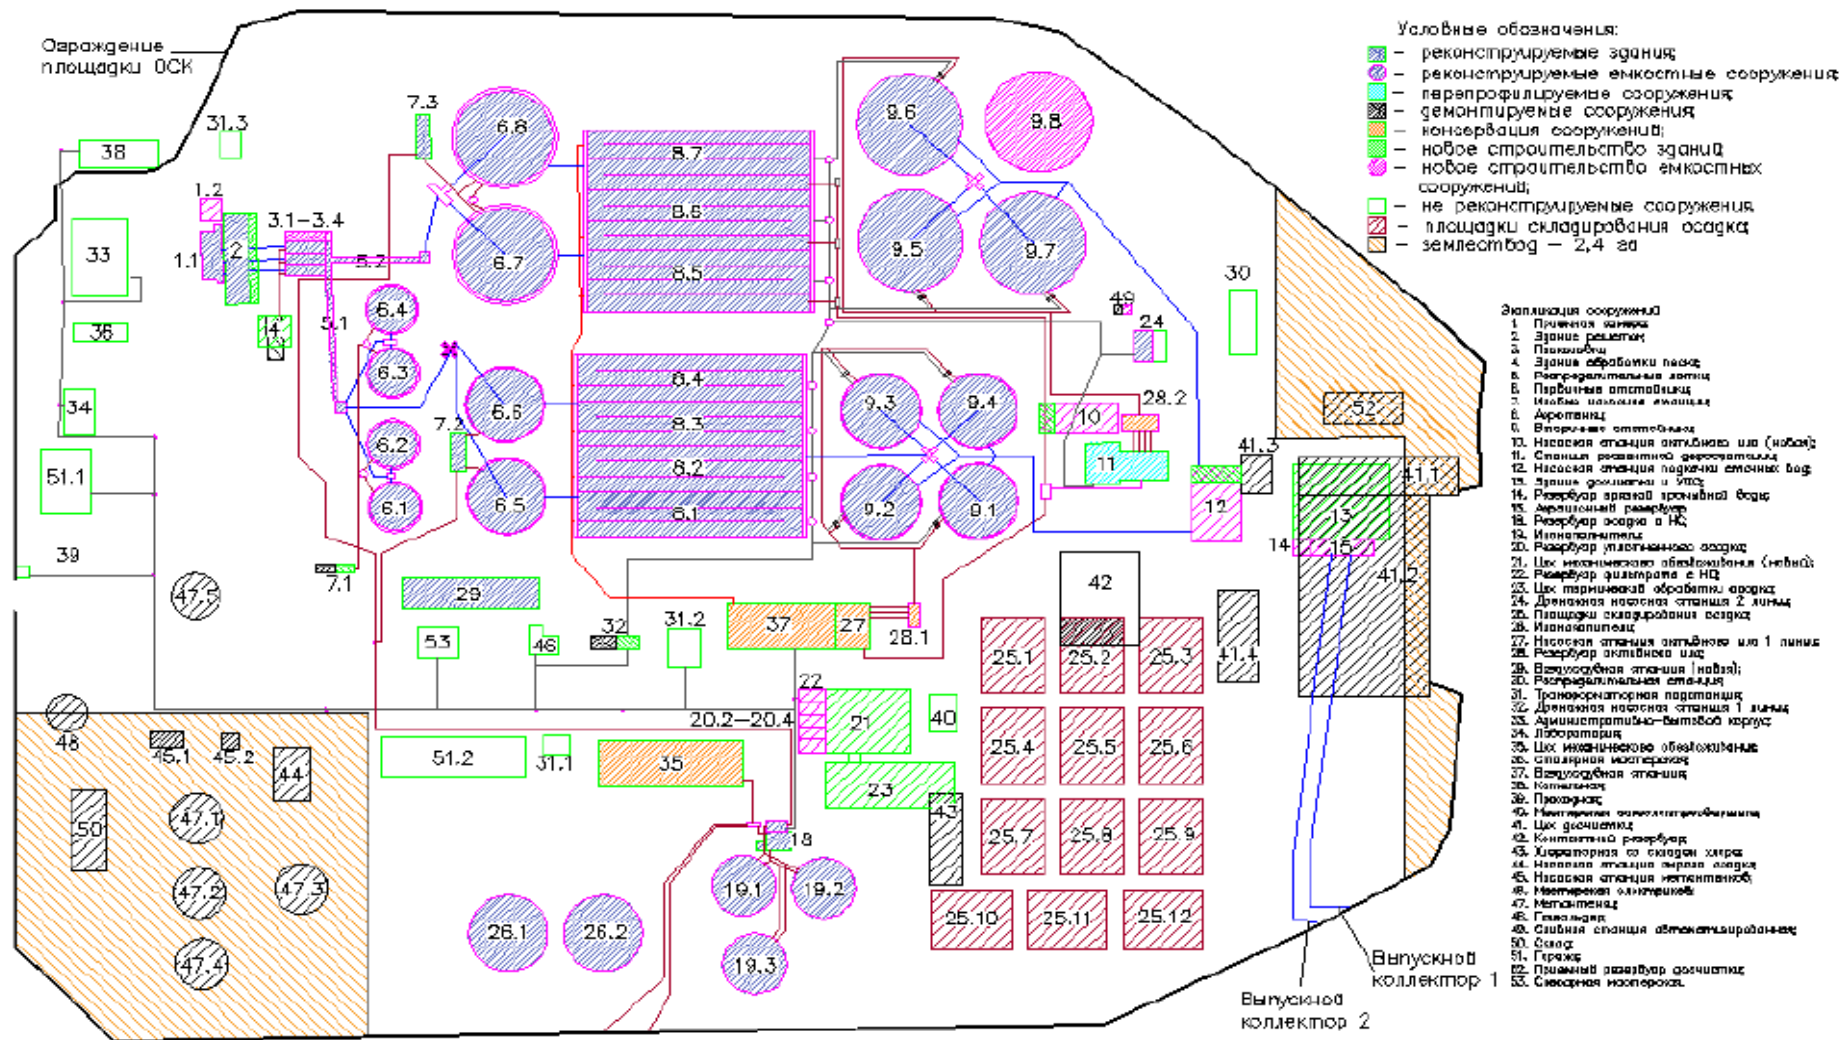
Компонировочные решения площадки ОСК при реконструкции (без учёта иловых площадок п. Нолька)
